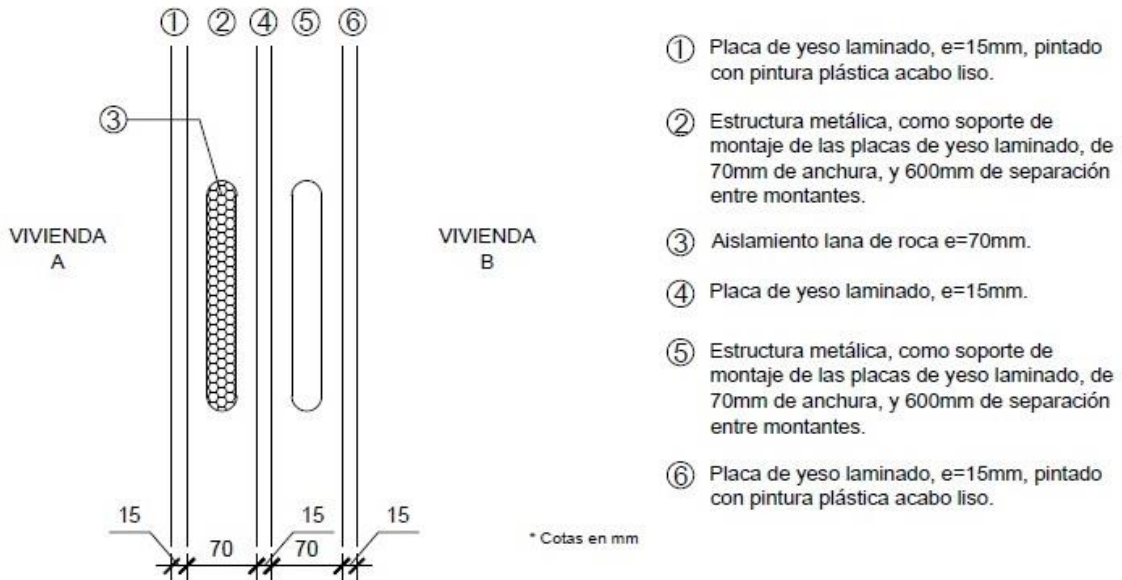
Cerramiento de medianería tipo "Vivienda A-Vivienda B"
